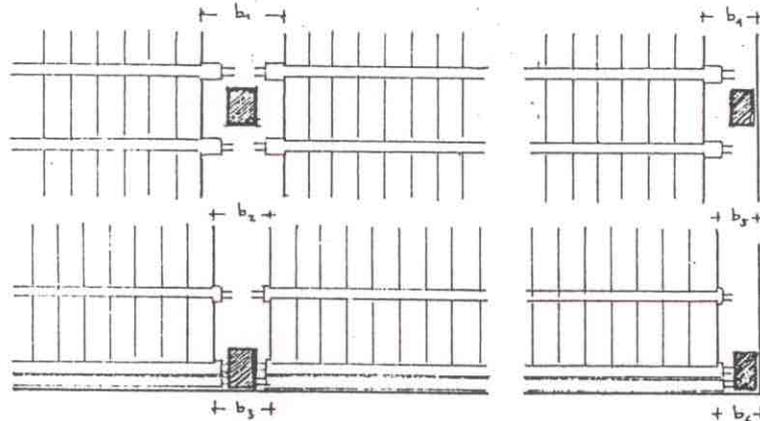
Nudos tipo en planta: interior, frontal, lateral y esquina
